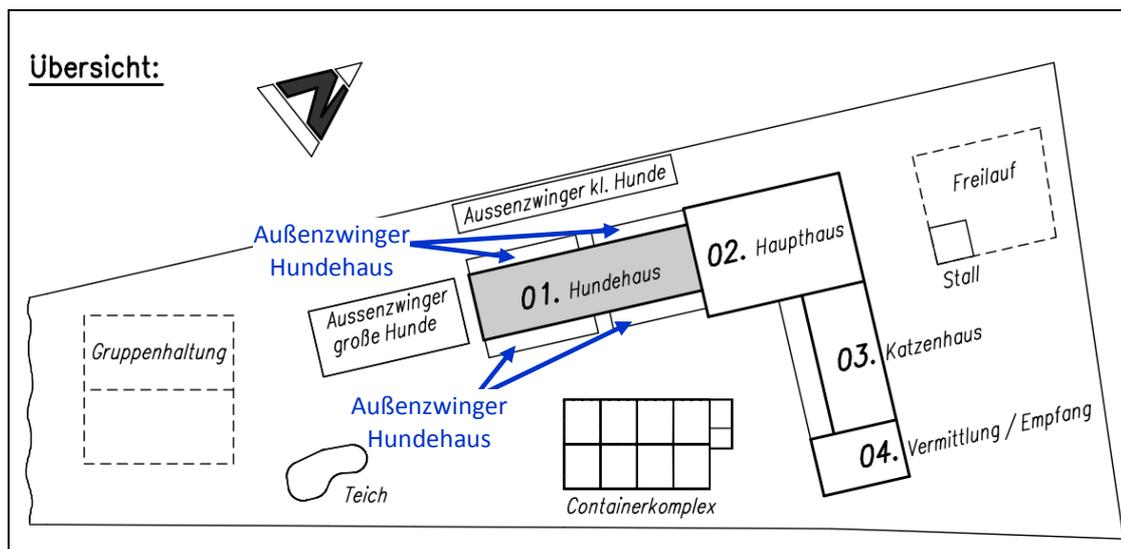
Übersicht mit geplanter Aufteilung des Betriebsgrundstücks
